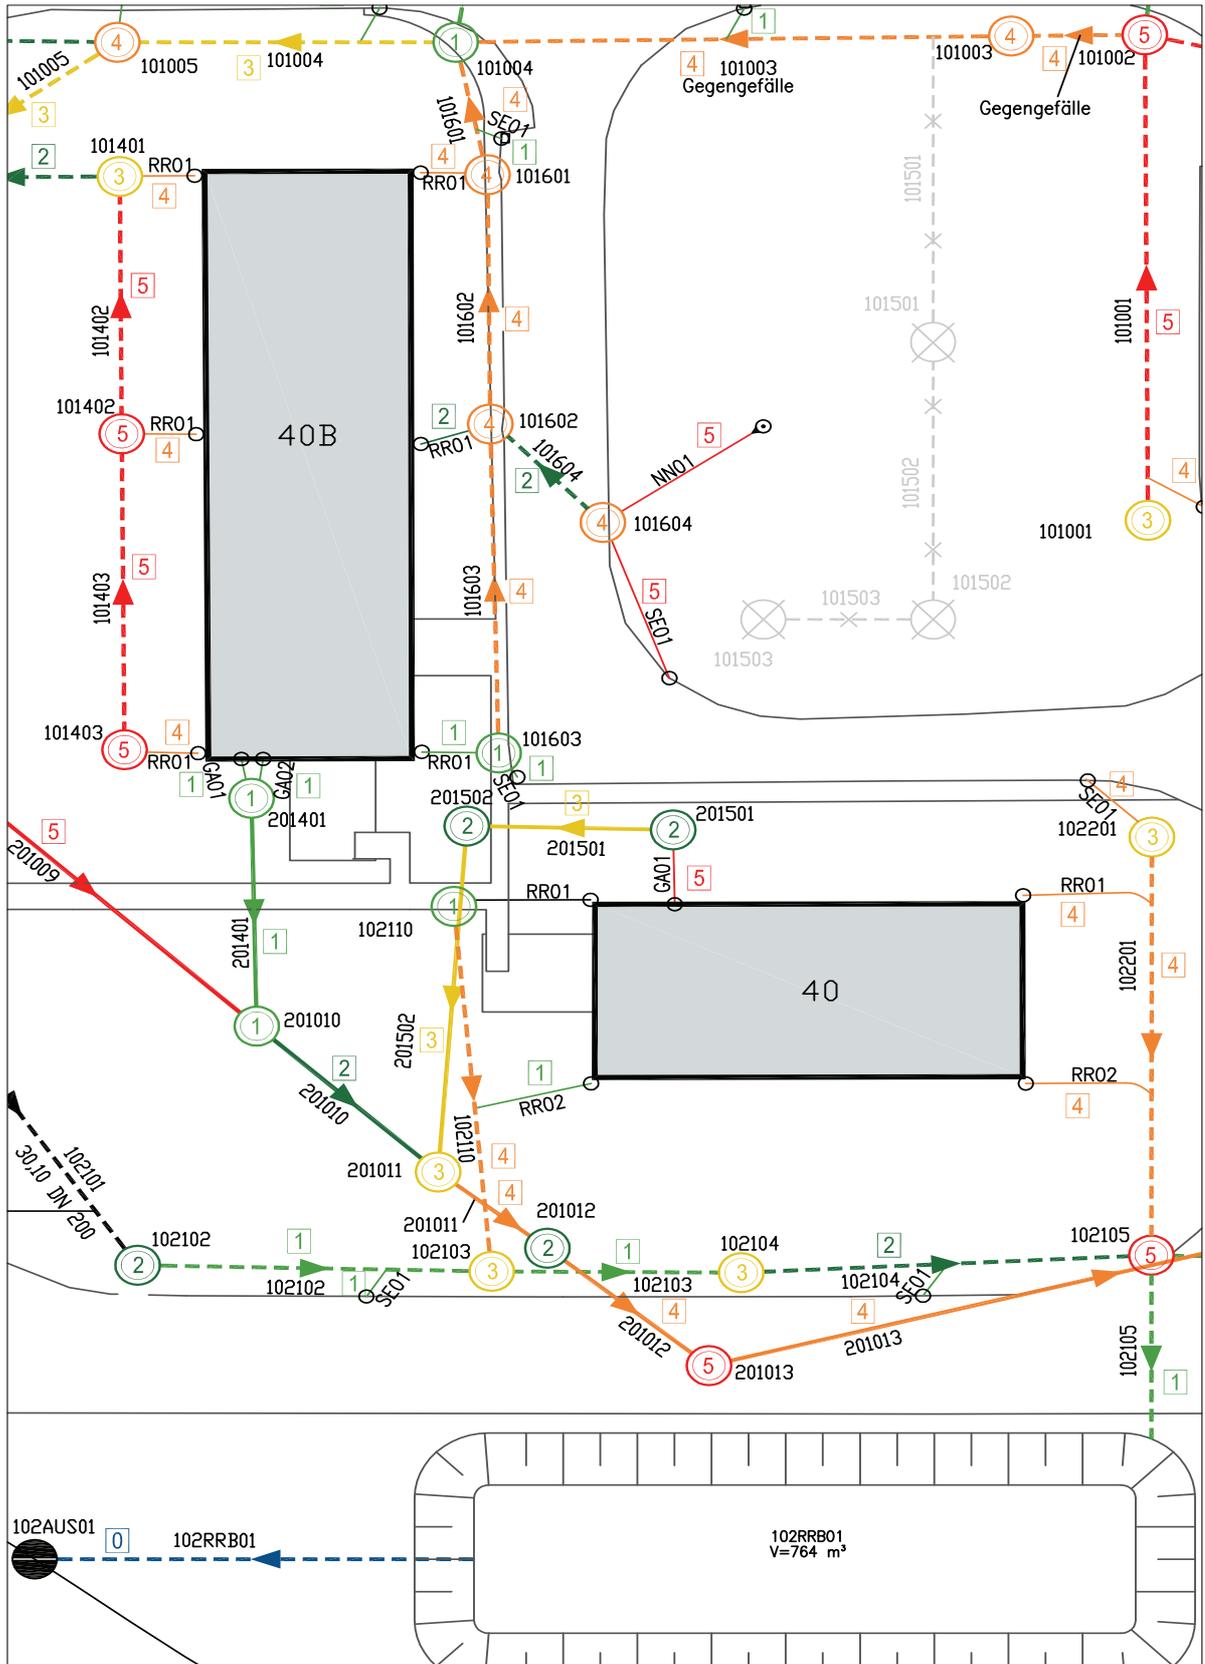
Beispielplan: Lageplan "Bautechnische Zustandsbewertung"
